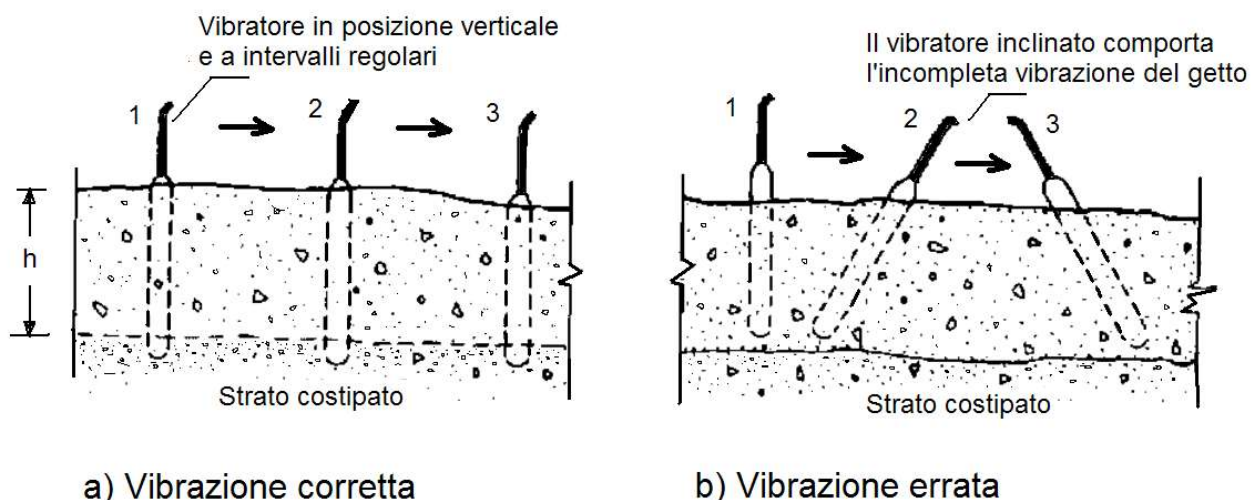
Esecuzione del getto e modalità di costipazione mediante vibrazione interna
